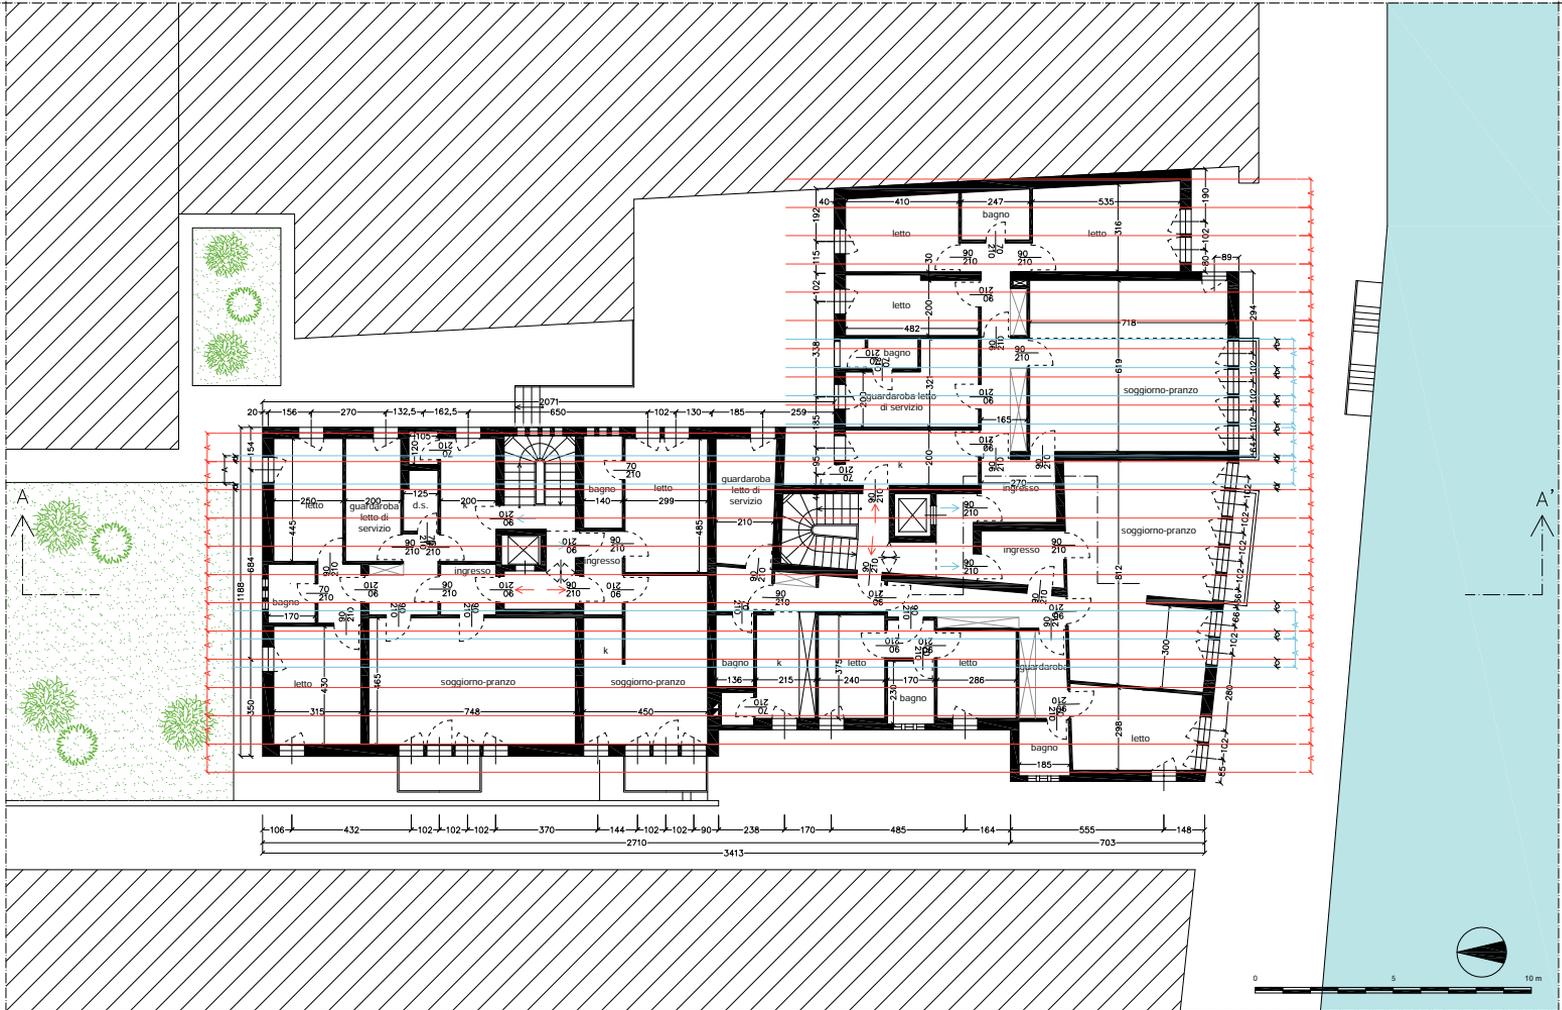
Casa alle Zattere, pianta del piano tipo con individuazione del sistema proporzionale.
